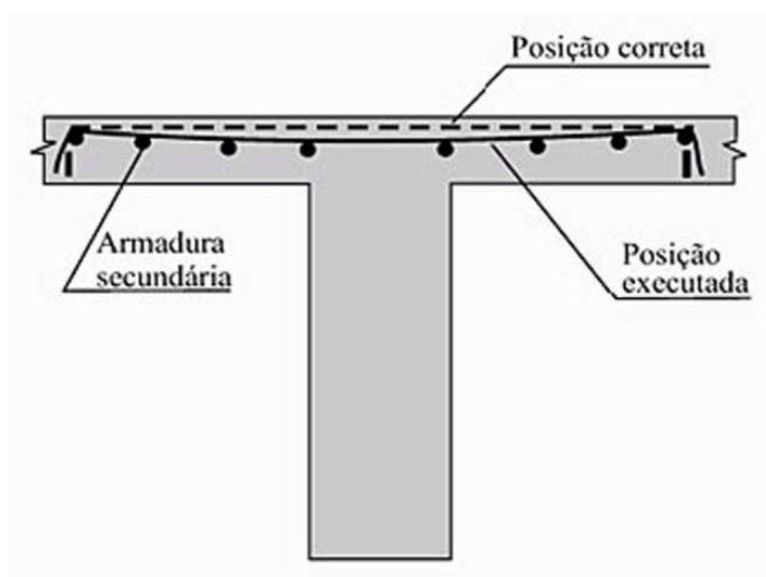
Deslocamento inadequado de armadura negativa em laje.
